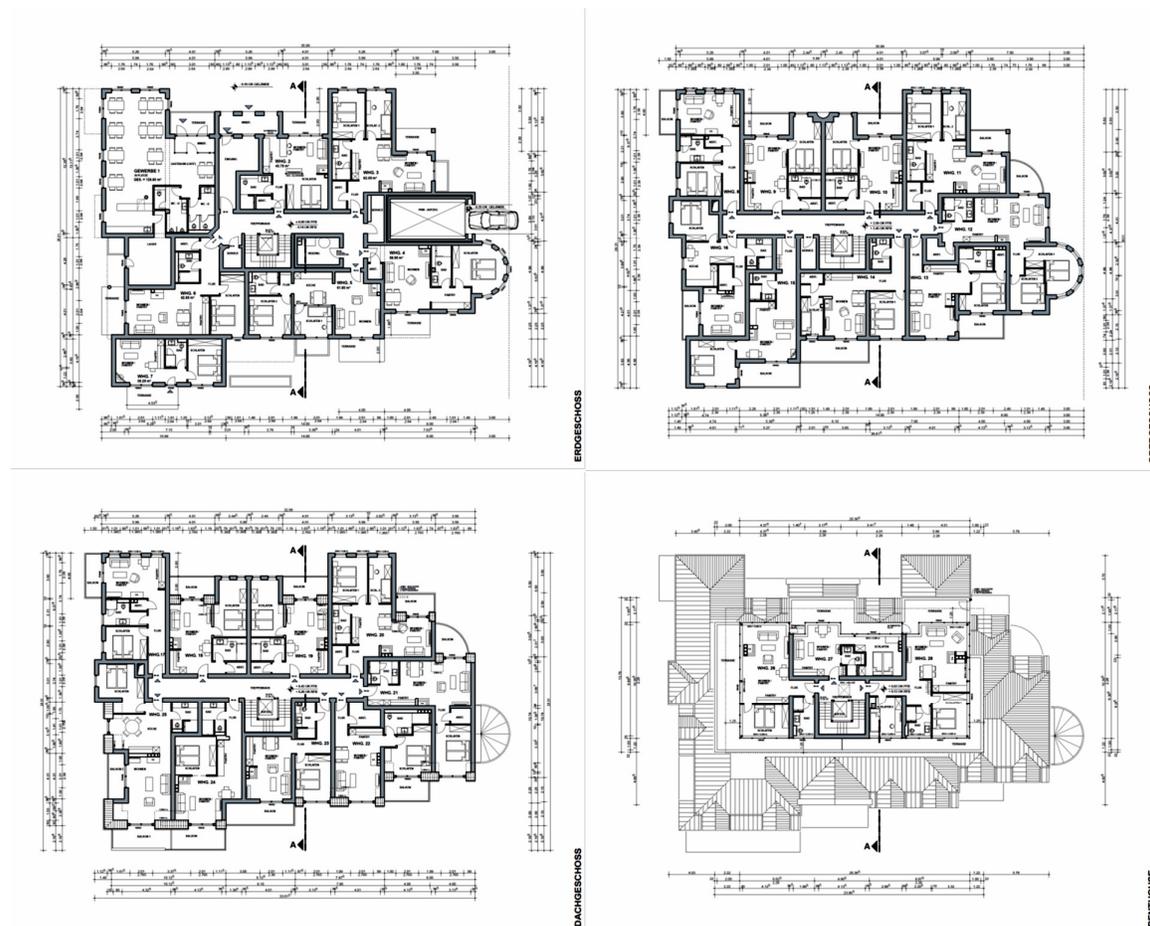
Grundrisse (Planungsgruppe Wöhlk)
